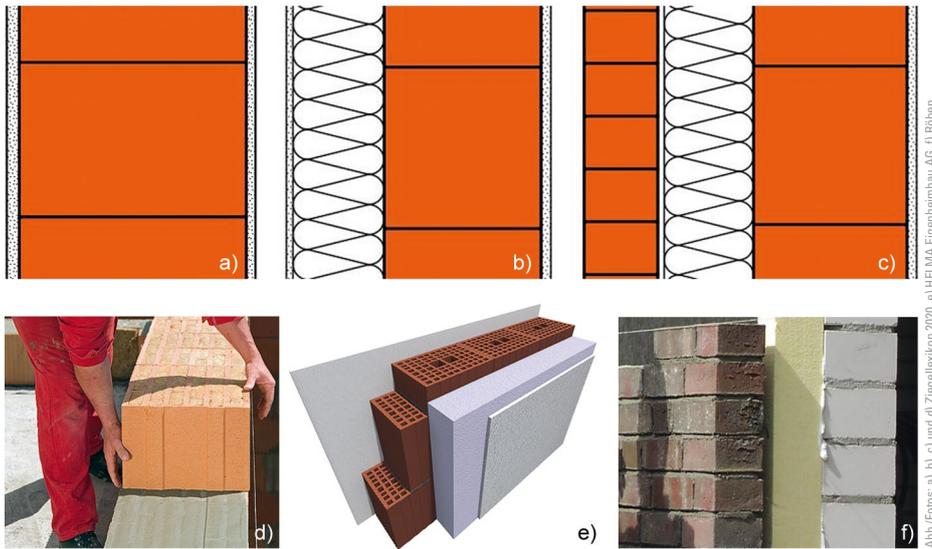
Typische Außenwandkonstruktionen aus Mauerwerk: a/d) Monolithisches Mauerwerk [1], b/e) zusatzgedämmtes Mauerwerk, c/f) zweischaliges Mauerwerk
